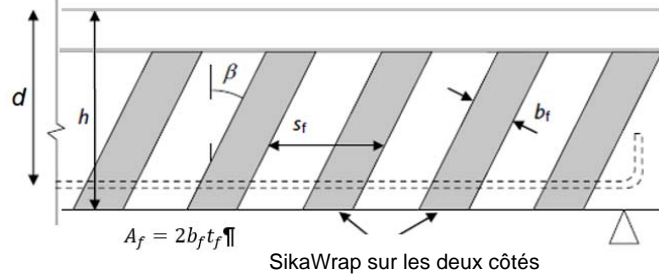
Principe de renforcement à l'effort tranchant – Poutre T
